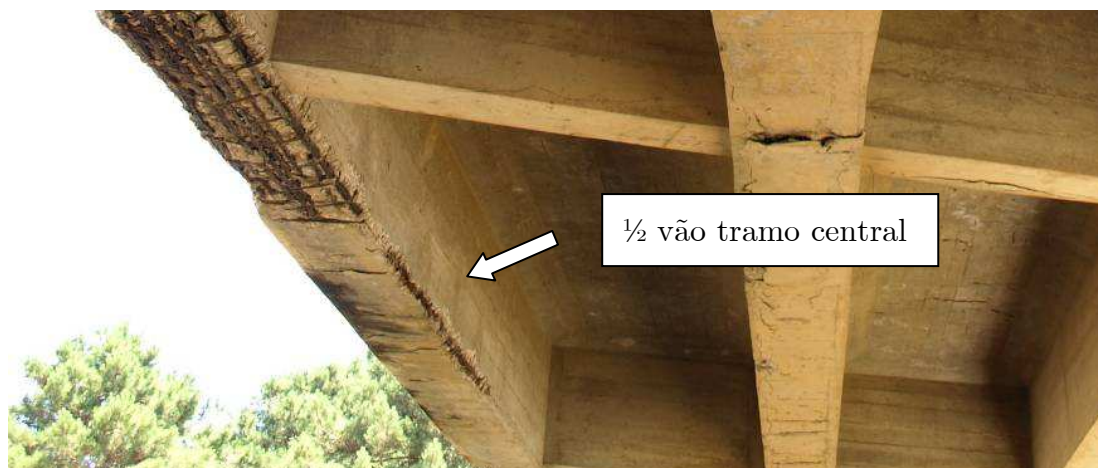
Estado da secção de interesse — meio vão do tramo central da viga 1.
